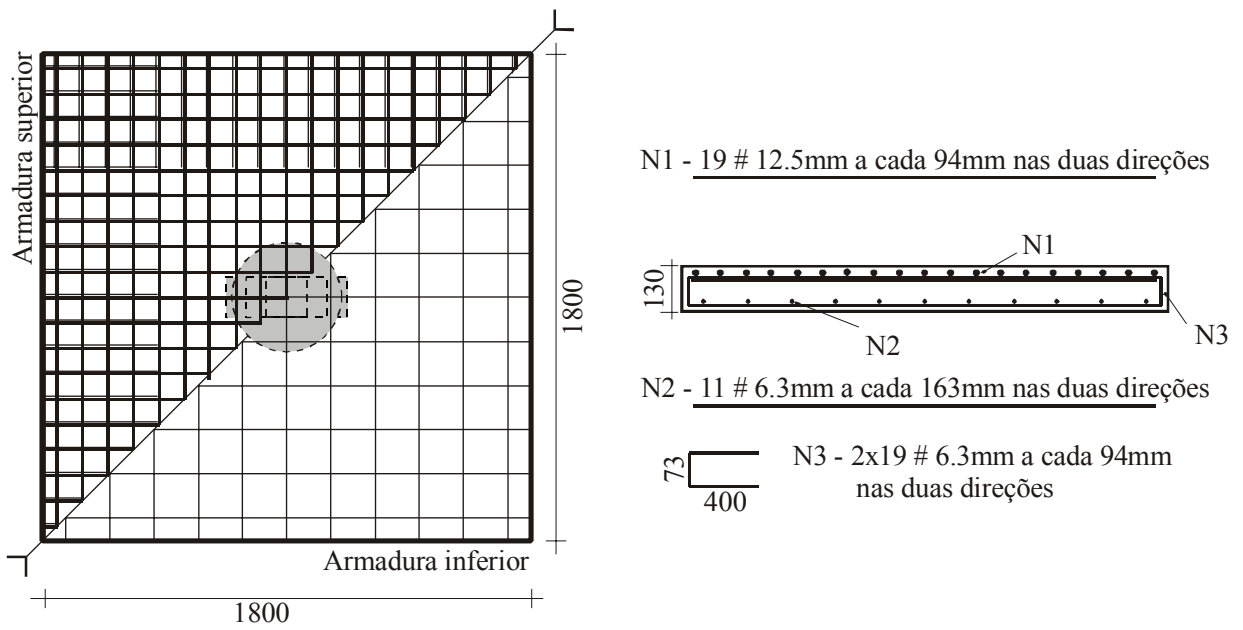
Lajes testadas por SILVA (2003) – (mm)
